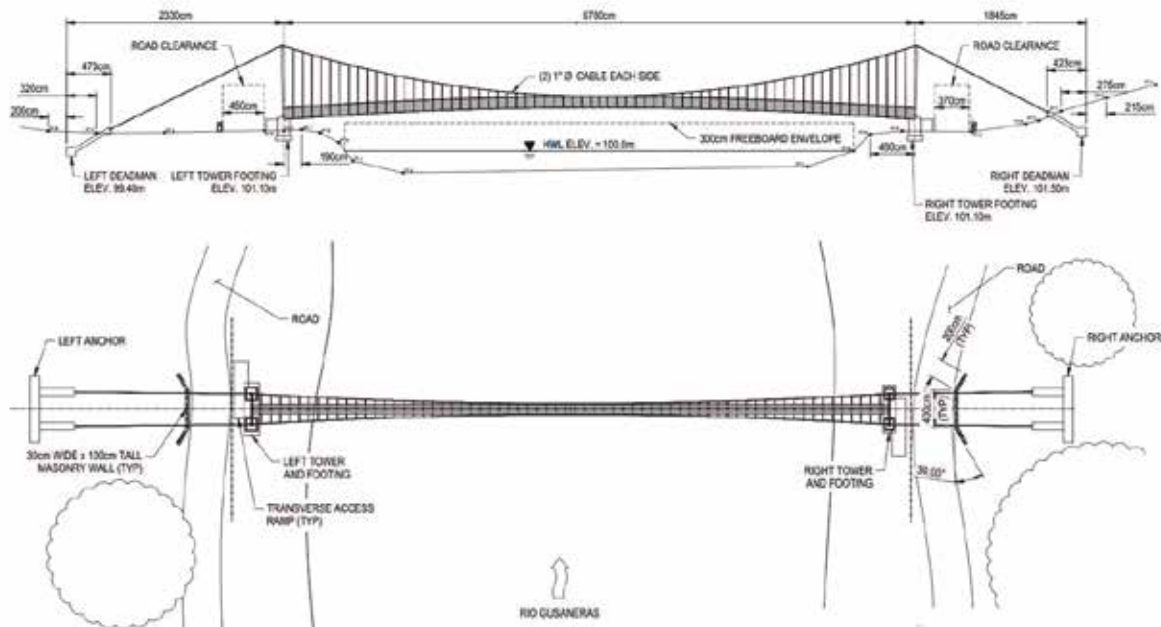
Alzado y planta general de la Pasarela San Vicente
